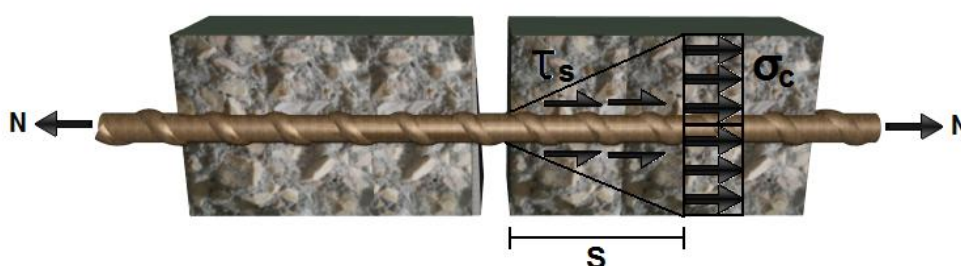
Distribuição das tensões dentro do betão armado depois da fendilhação (adaptação Marchão, 2007).
